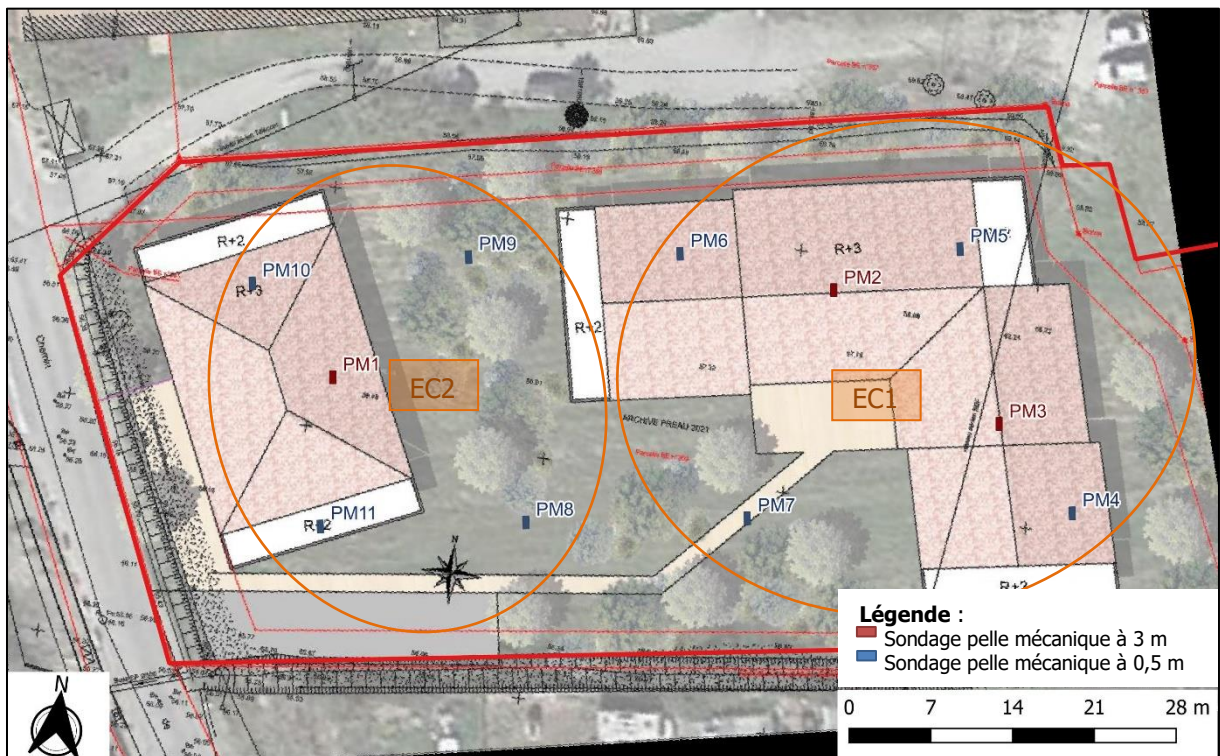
Localisation des sondages environnementaux sur plan masse projet
